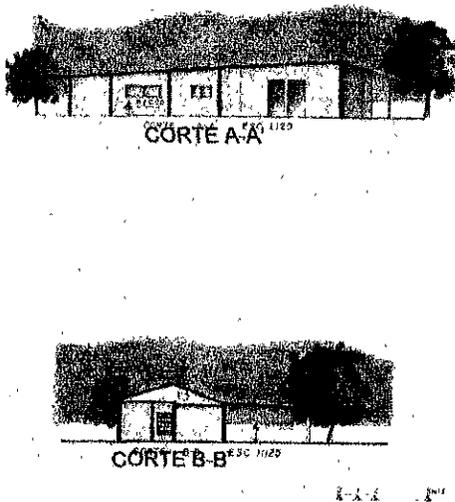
Cortes longitudinal A-A' y transversal B-B', caso 9
